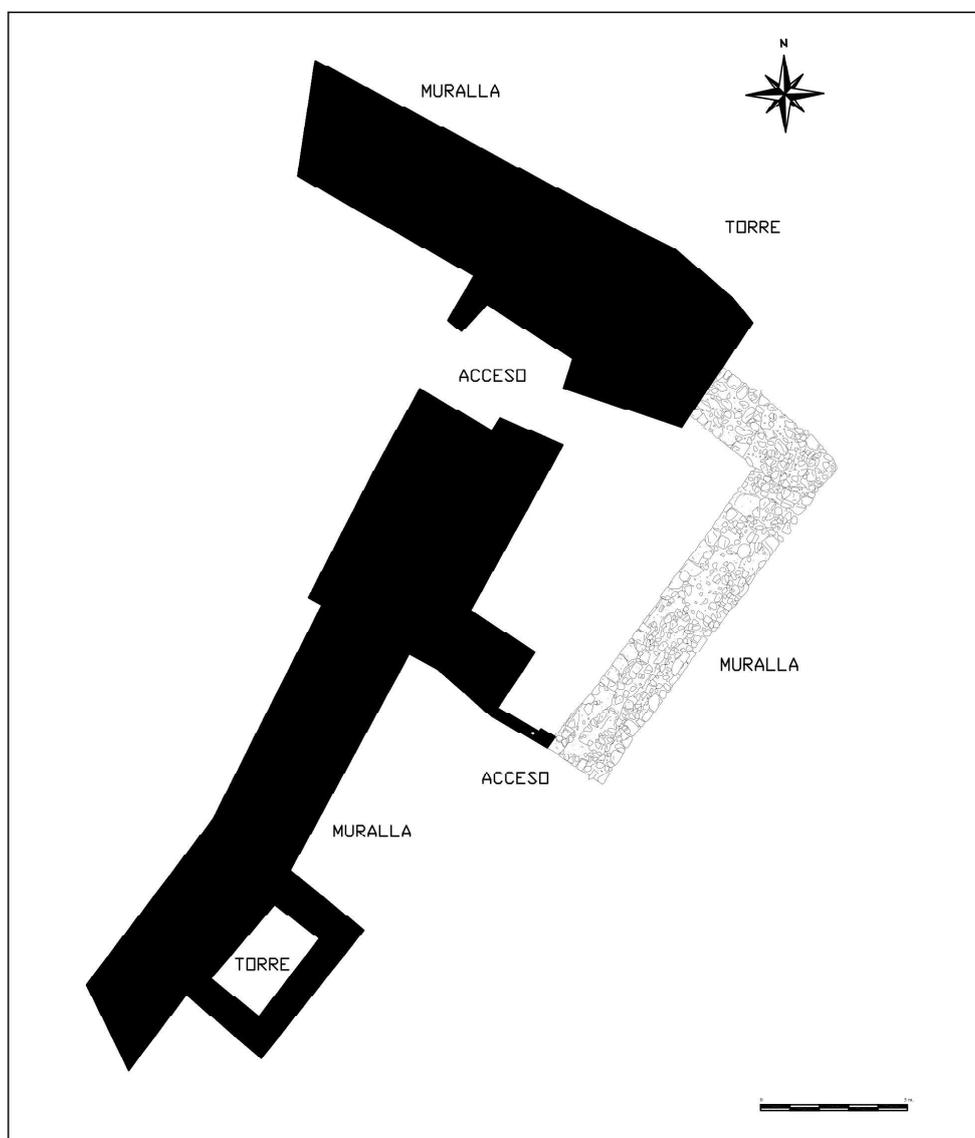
Planimetría arqueológica de la puerta oriental en época visigoda tras la excavación del muro avanzado o barbacana.
